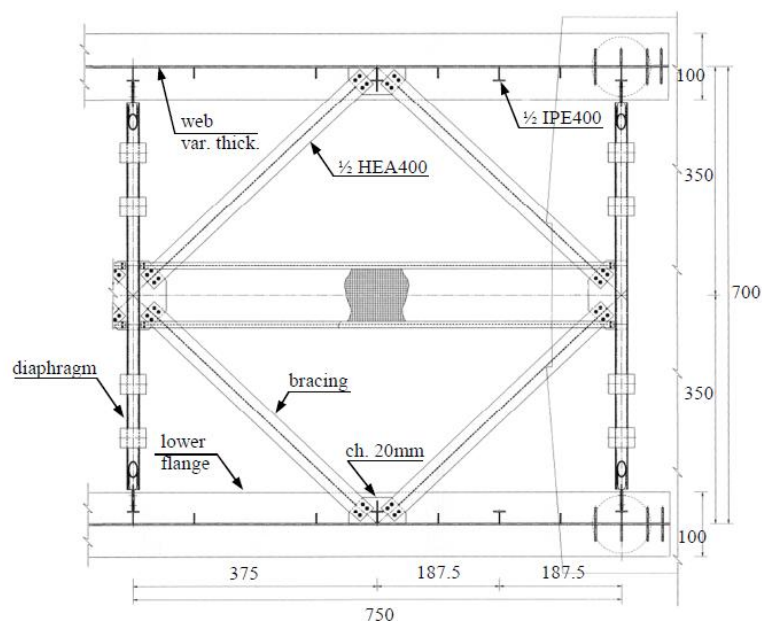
Detalhes dos elementos estruturais metálicos do viaduto (unidades: cm) (adaptado de Alencar et al., 2016)
